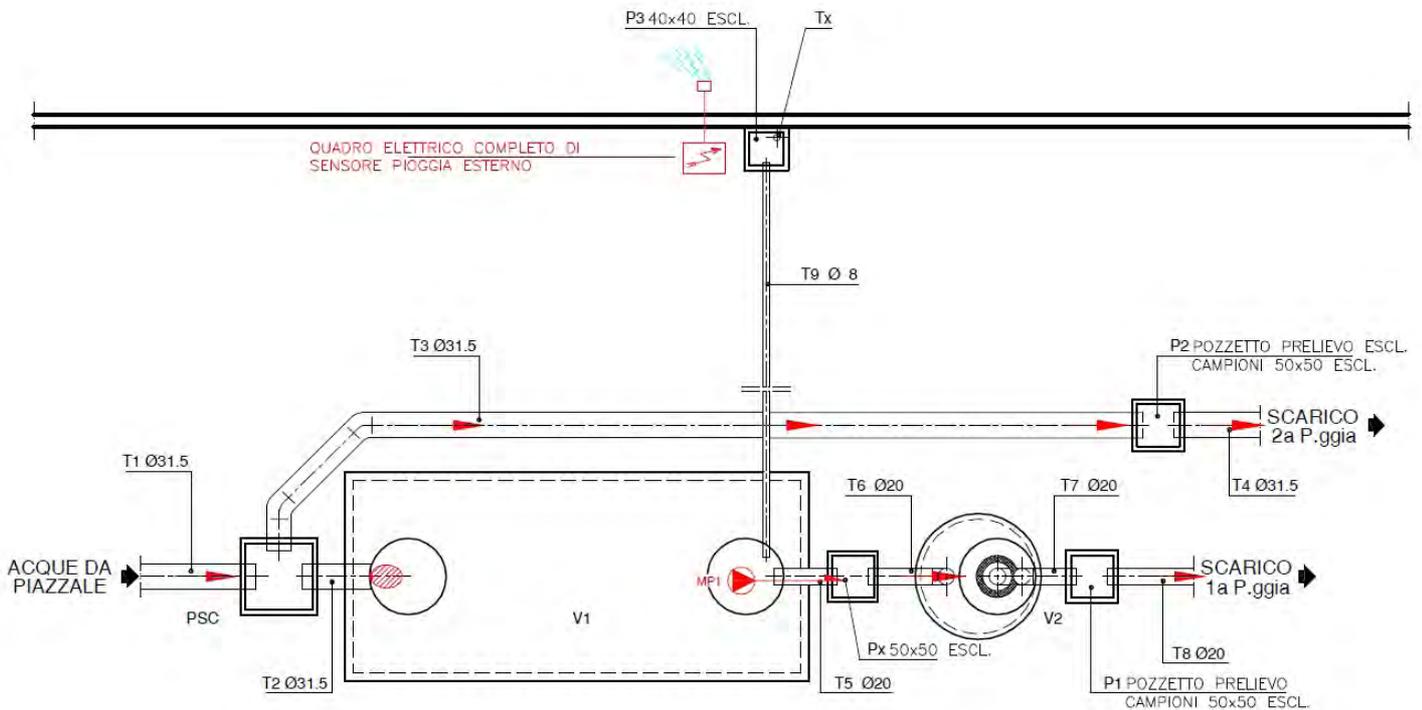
Disposizione planimetrica vasca di prima pioggia
